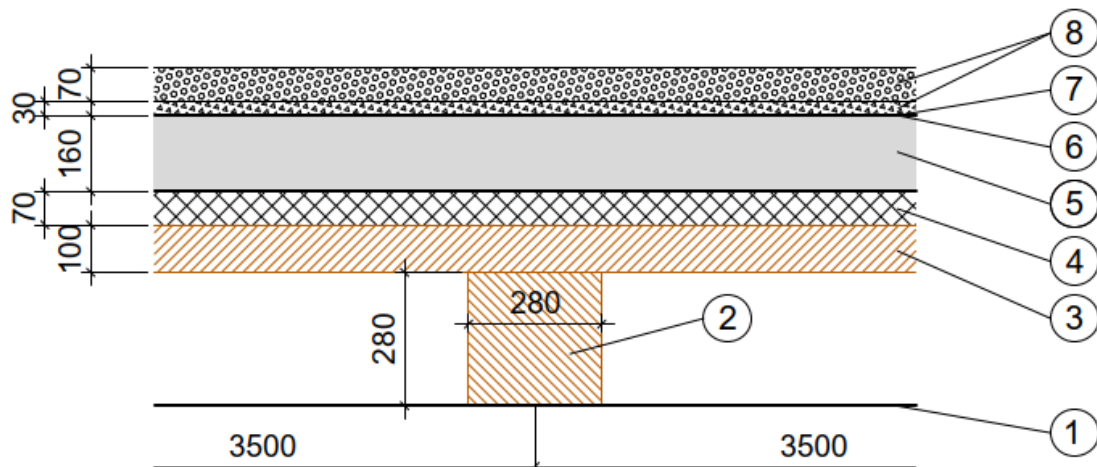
Aufbau Holz-Beton-Verbunddach (Brettstapel)
